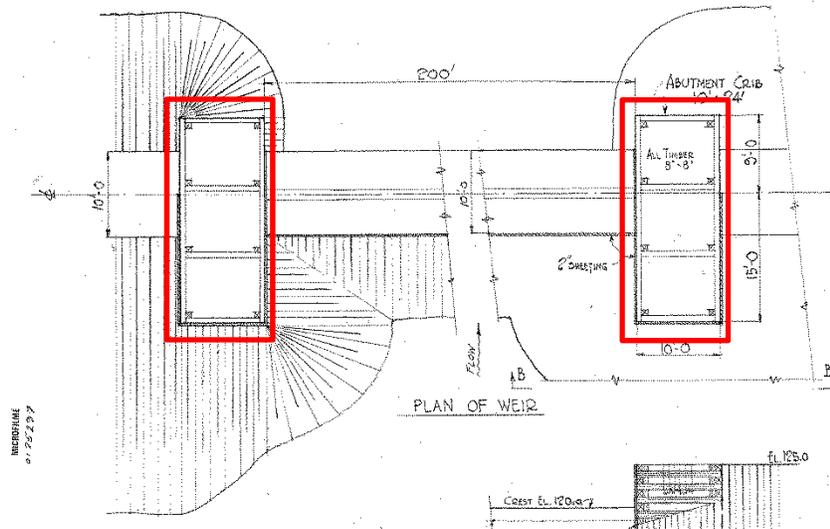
STRCT1 – Vue en plan du seuil en béton 1941 (±PM 200 à 270)
